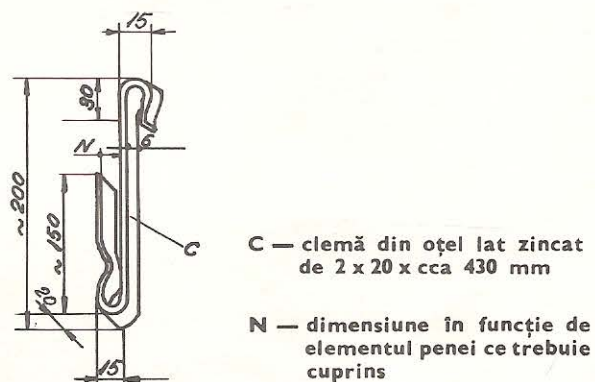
h. Atașă galvanizată, pentru pană metalică
